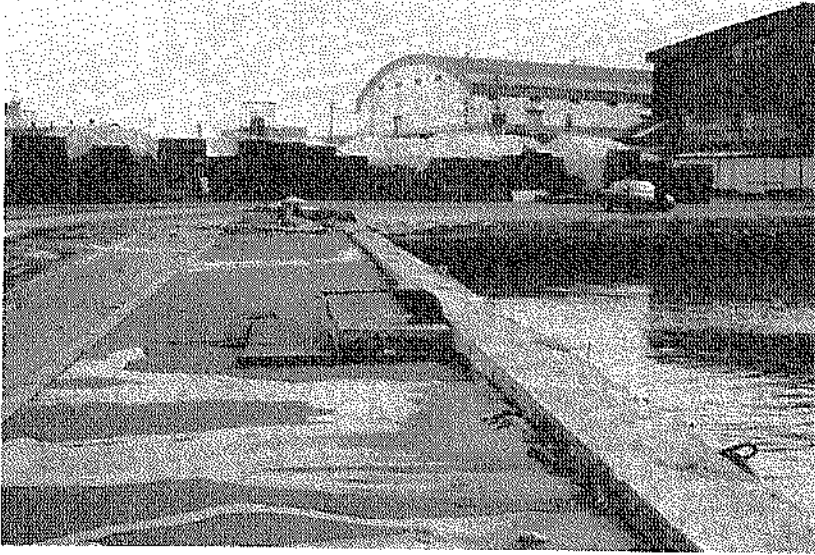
中央埠頭地区，物揚場(-2.0m)
